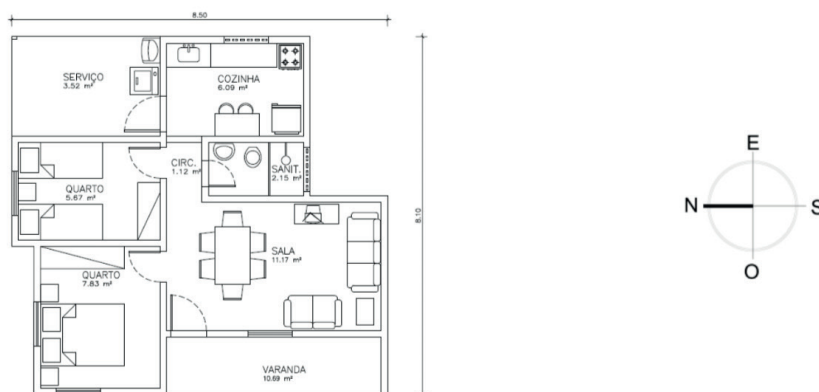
Planta baixa edificação. Fonte. Adotado de Estudiofarol.
